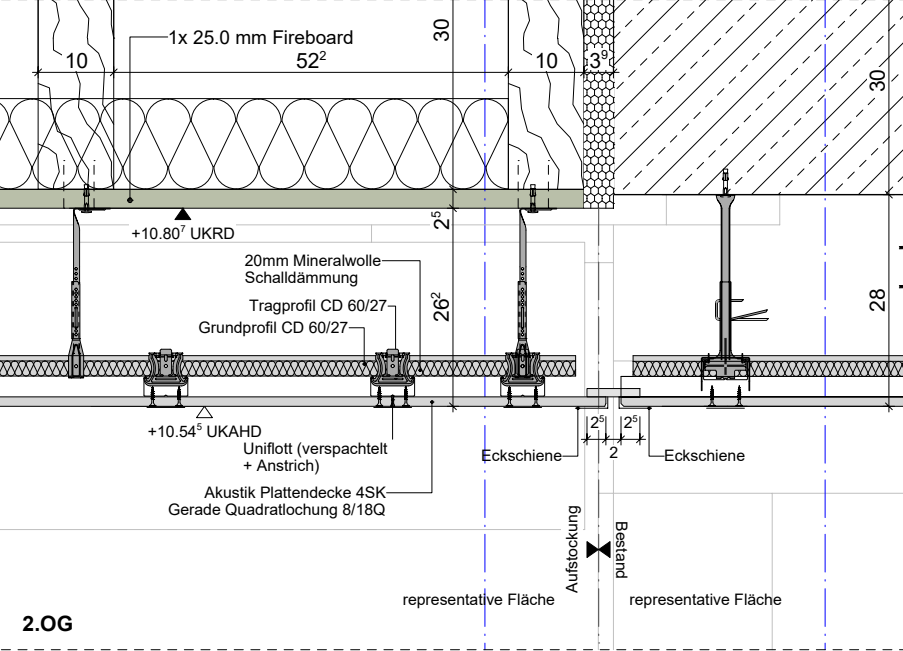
Decke 2 - Längsschnitt Wandanschluss
